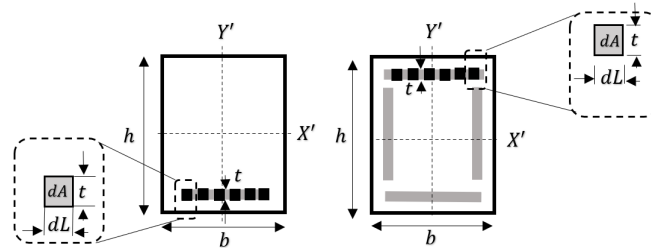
Modelado por discretización del ISR para secciones: (Izq.) Viga y (Der.) Columna.
